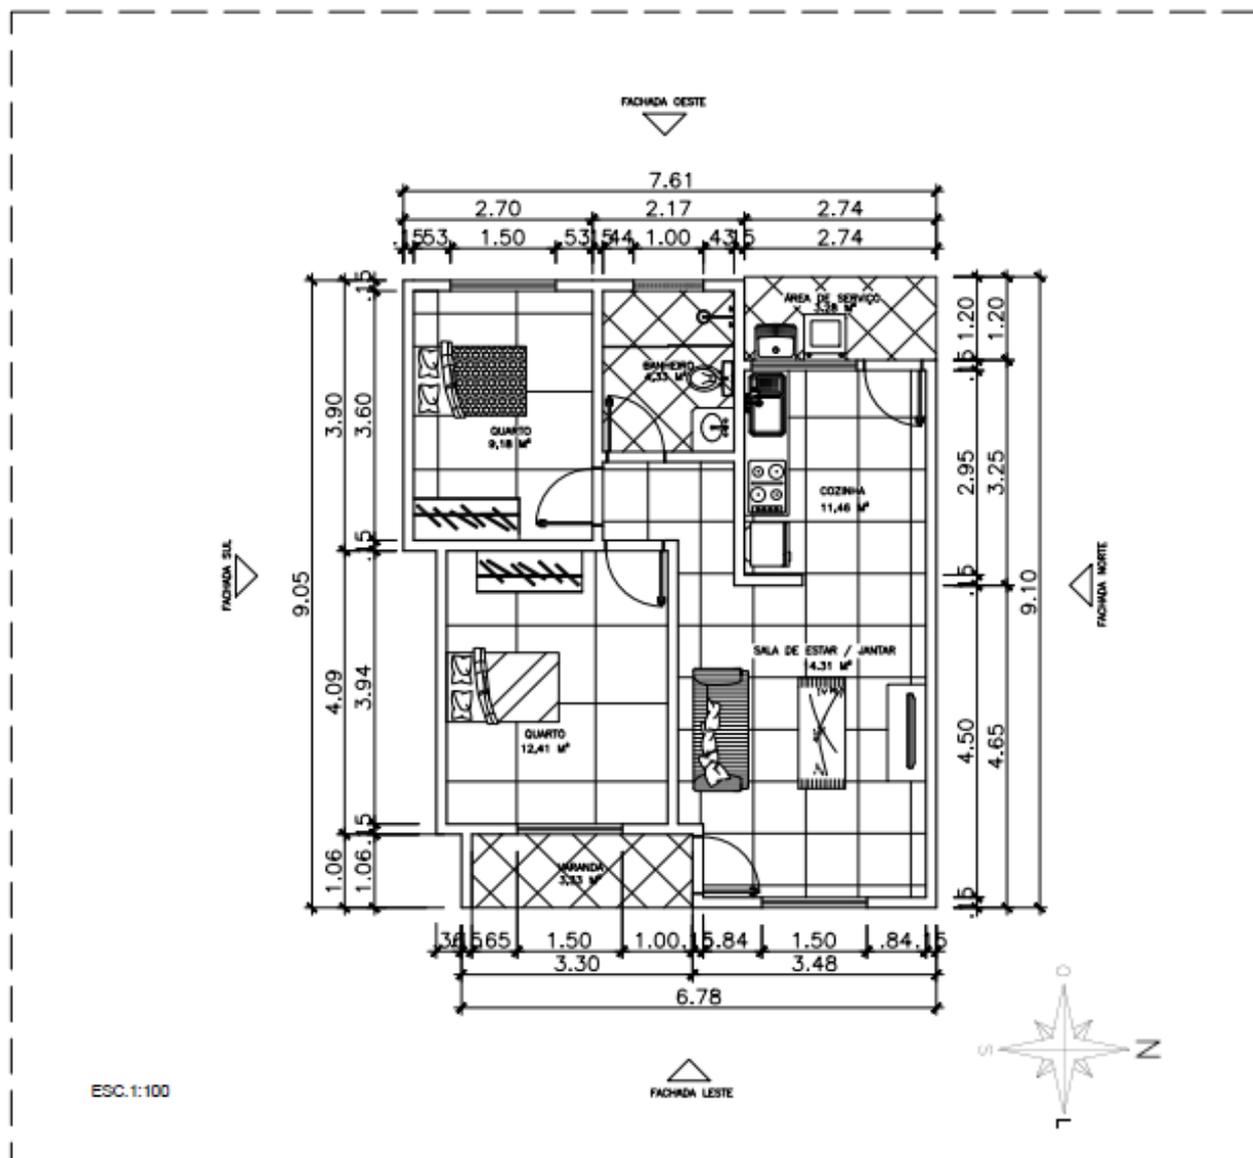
Planta baixa da casa analisada (Autor, 2014).
